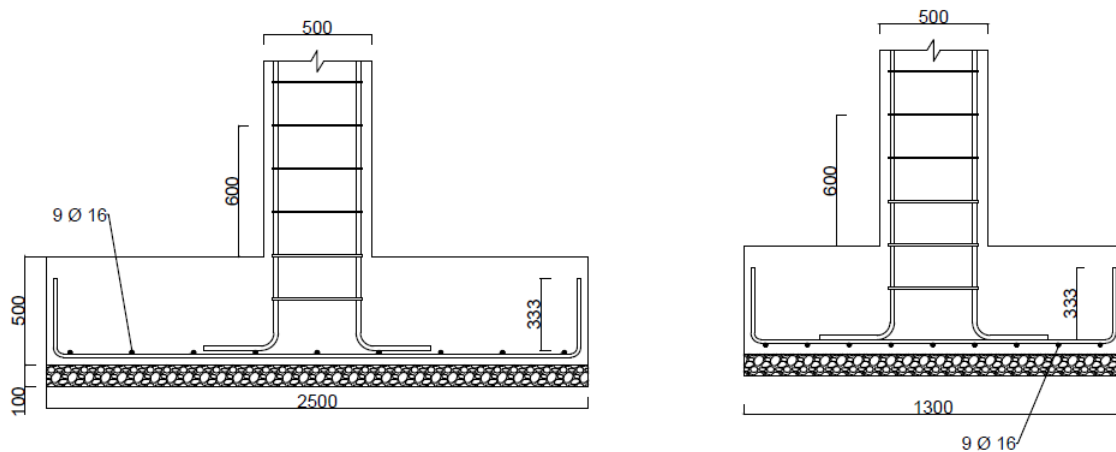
Dimensiones y armado de las zapatas testeras (fuente: elaboración propia)
